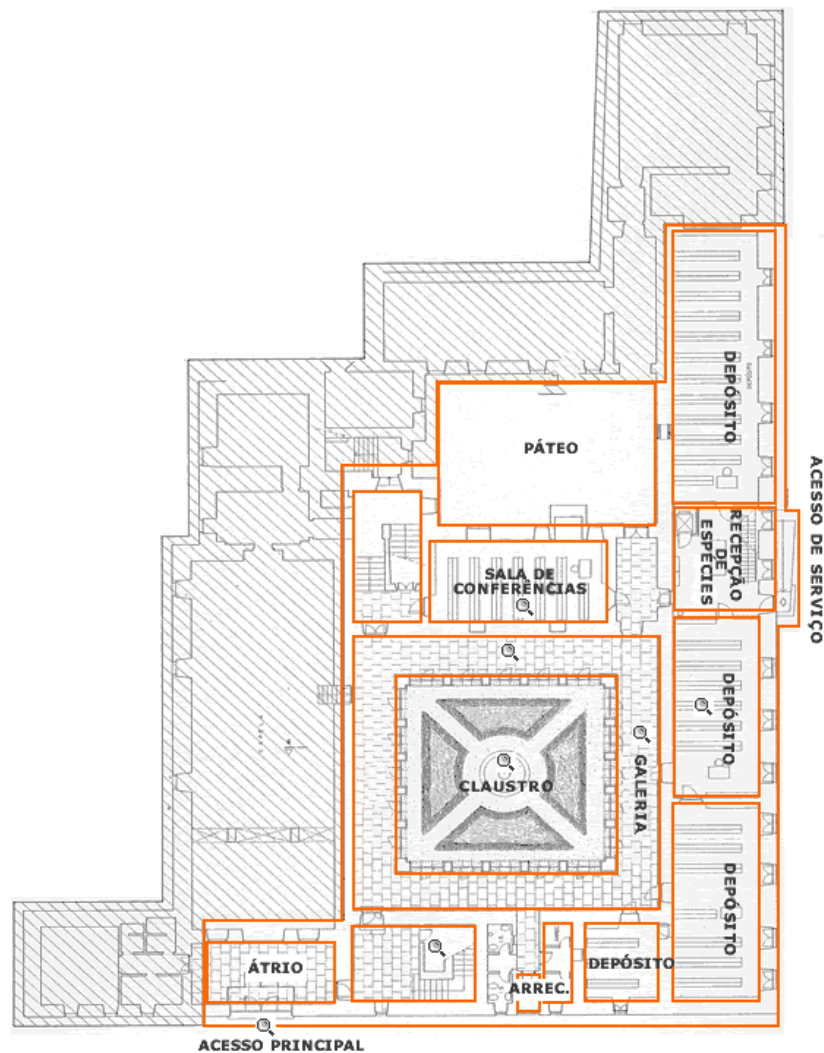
Planta da área ocupada pelo arquivo no piso 0. Fonte: www.adgrd.pt.
